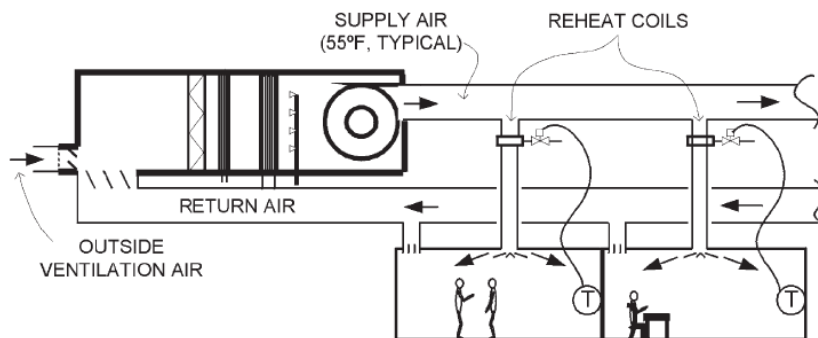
Esquema de sistema de conduta única, reaquecimento por zona e volume constante (McDowall, 2007).
